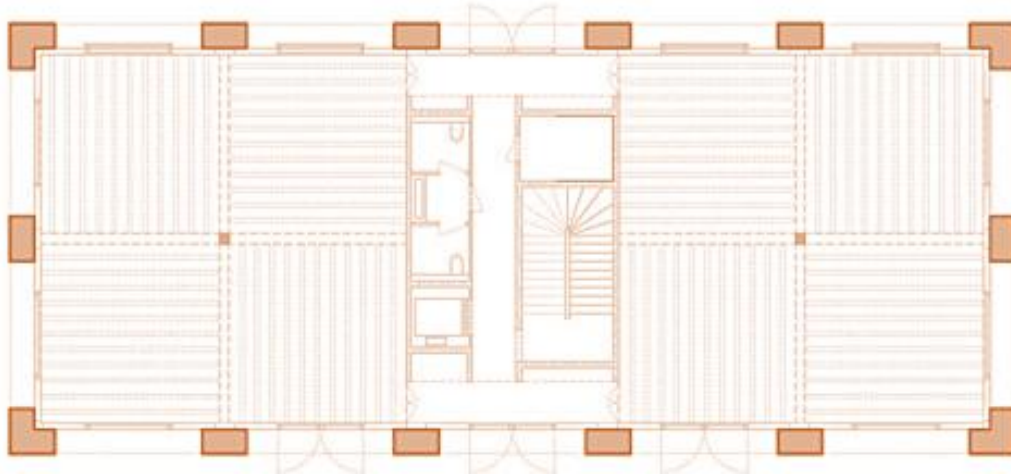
Planta do piso térreo. Simetria e núcleo centrado. Imagem editada pela autora. Fonte – [internet]
